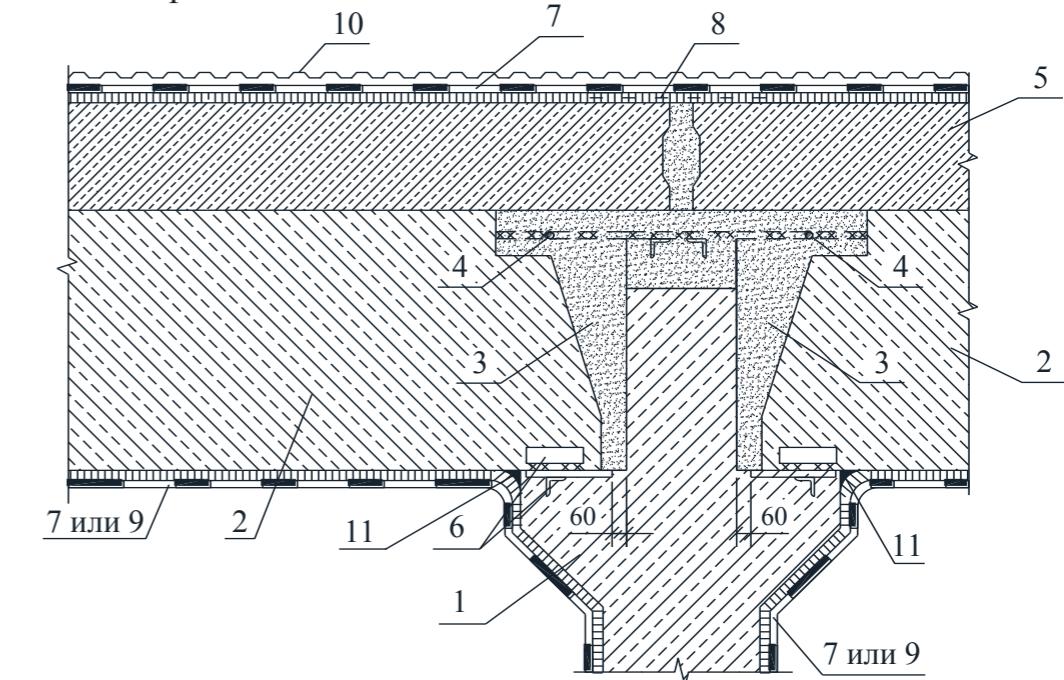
Узел 3. Сопряжение покрытия и стены прямоугольного каркасного резервуара
